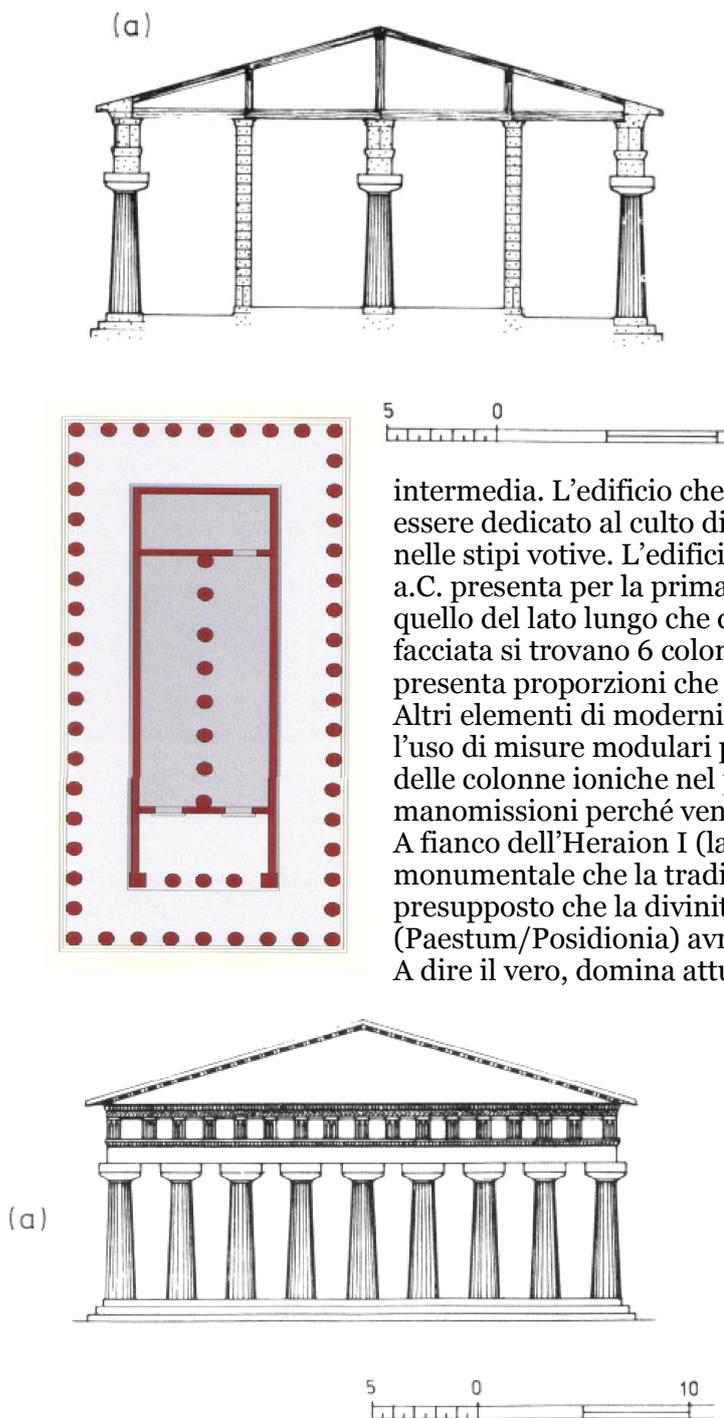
Sezione, planimetria e alzato dell’Heraion I di Paestum (Posidonia).
